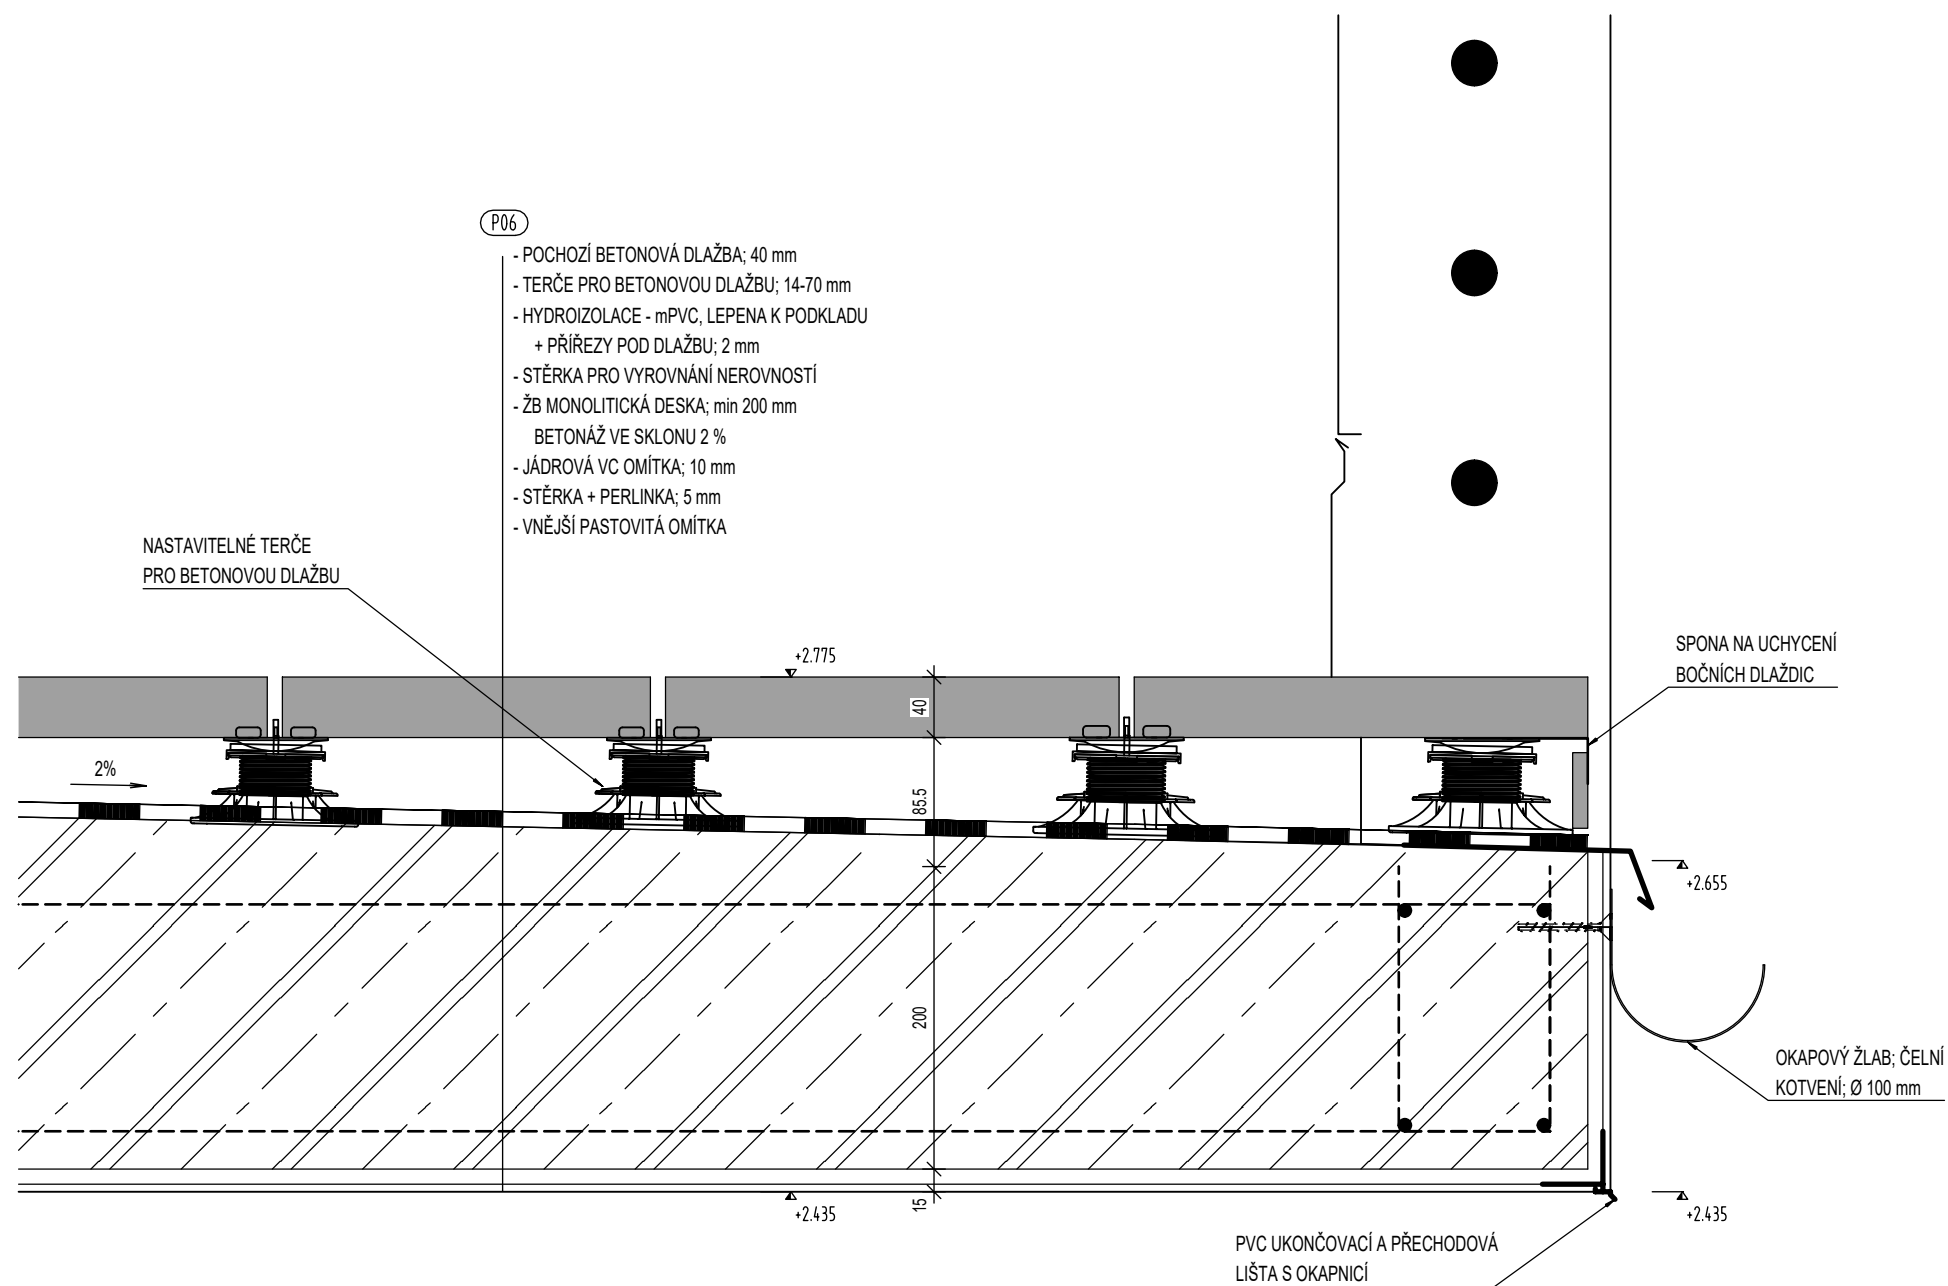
DETAIL SDRUŽENÉHO VYÚSTĚNÍ
